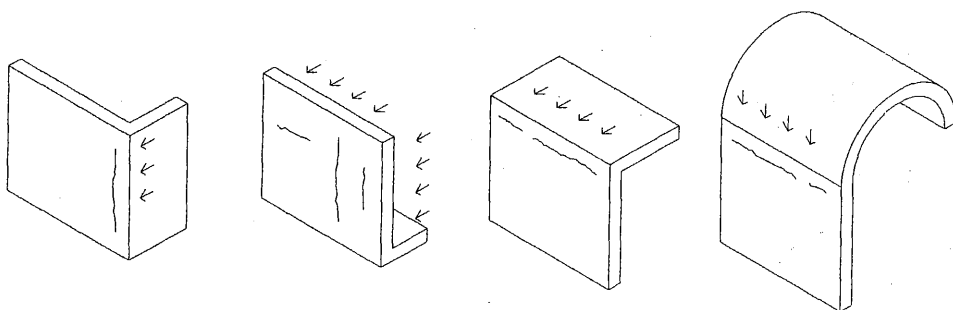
Grietas por empuje de muros perpendiculares.
